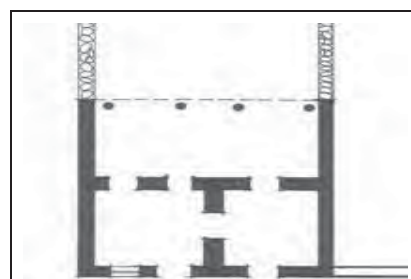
Planta Arquitectónica de modelo da casa colonial popular.
